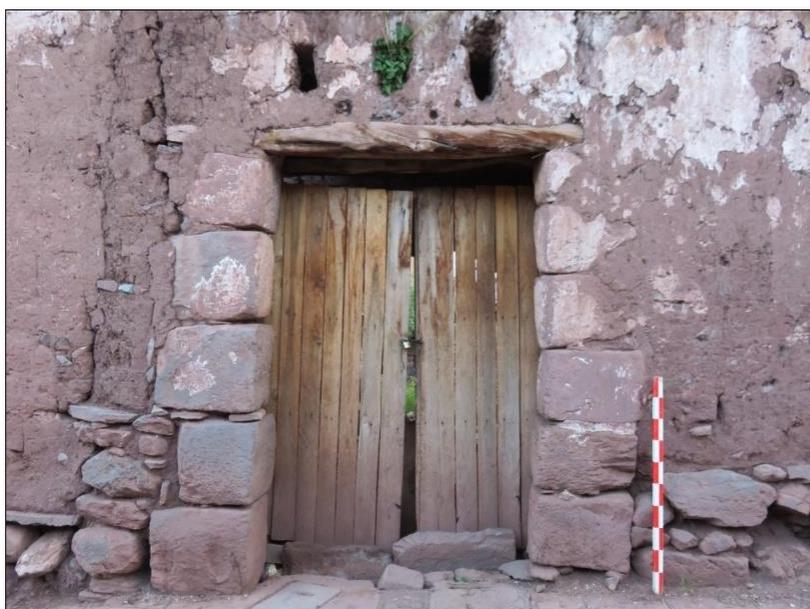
Segmento de muro Inka, así mismo obsérvese la reutilización de bloques líticos para la construcción del templo San Martín de Tour de Huarucondo. Fuente: A. Huaman.
